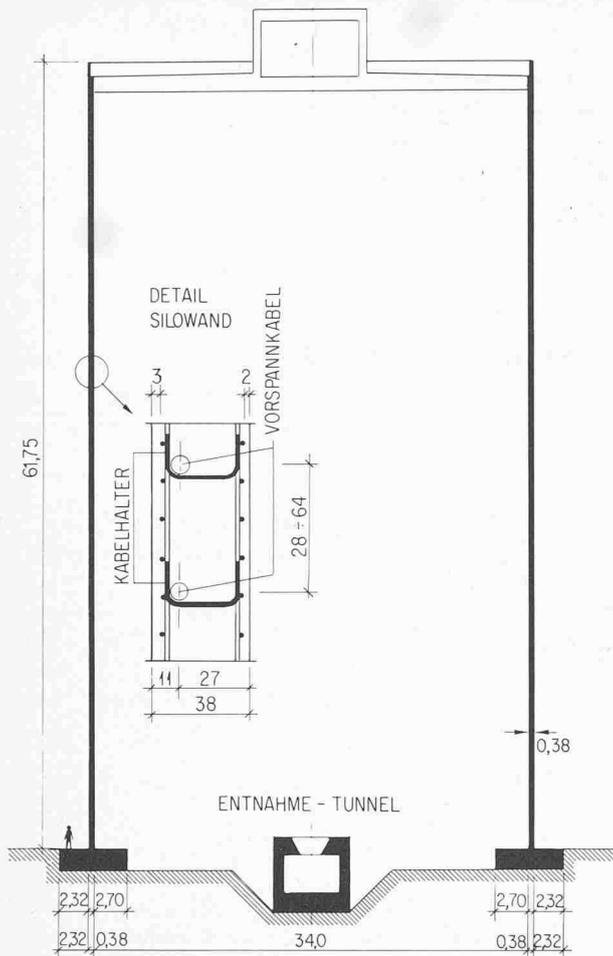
(links). Grundriss und Armierungsdetail des Klinkersilos Rekingen
